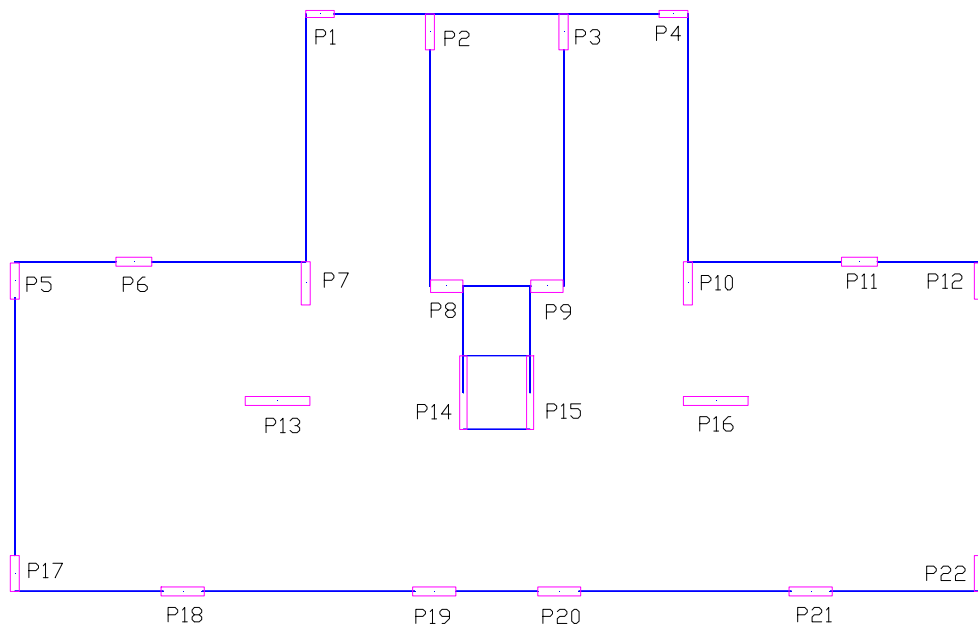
Planta baixa do ed. Maison Versailles com seus pilares e eixos das vigas principais.
